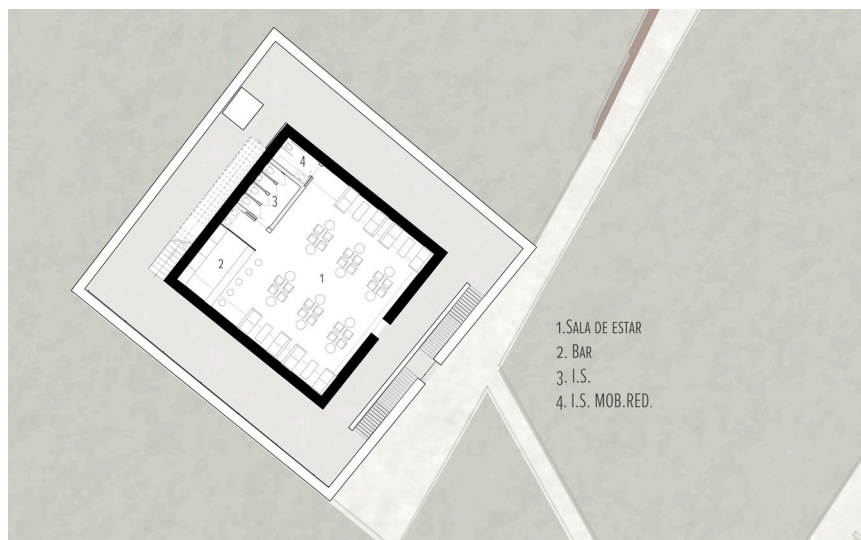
Bar-esplanada. Planta elaborada pela autora. 2018.
